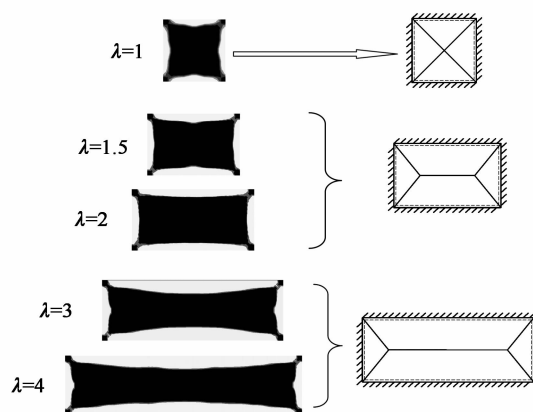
四周固支矩形钢筋混凝土板在各长宽比条件下的破坏形式
